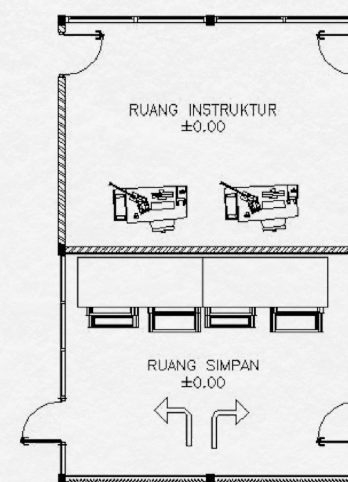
Layout Ruang Praktik Instalasi Jaringan
